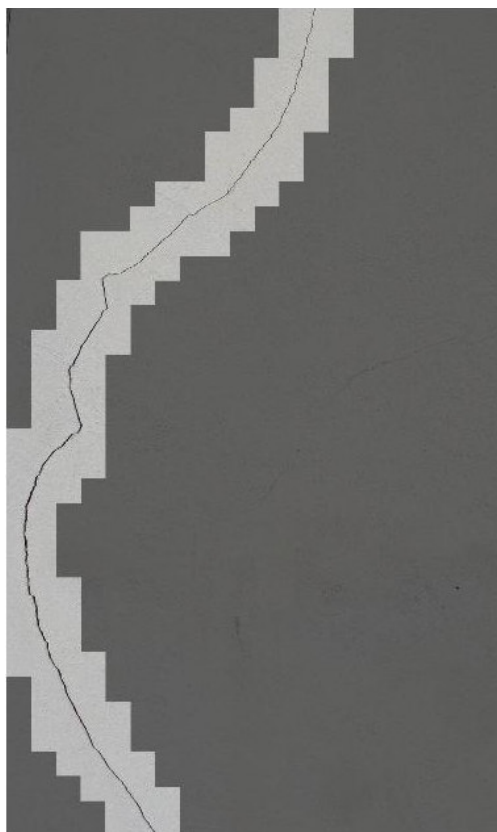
Detecção Fissura Z.F.10
